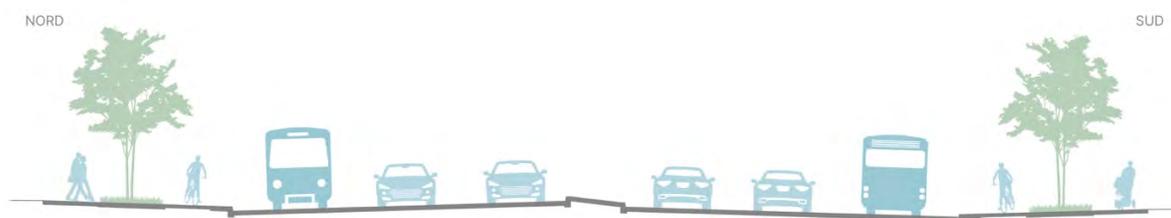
Coupe boul. Guillaume-Couture (Pôle Chaudière)
